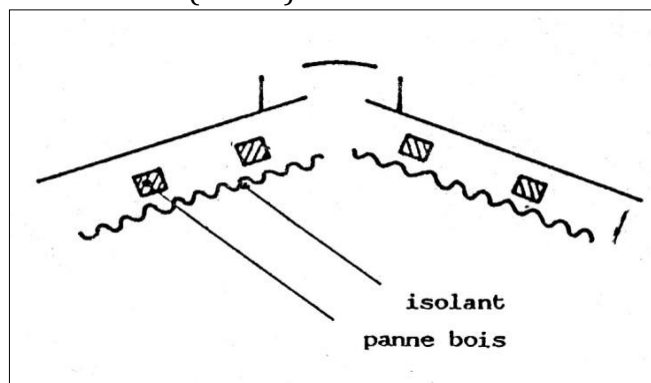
Exemple d'isolation de sous toiture (ITELV)
